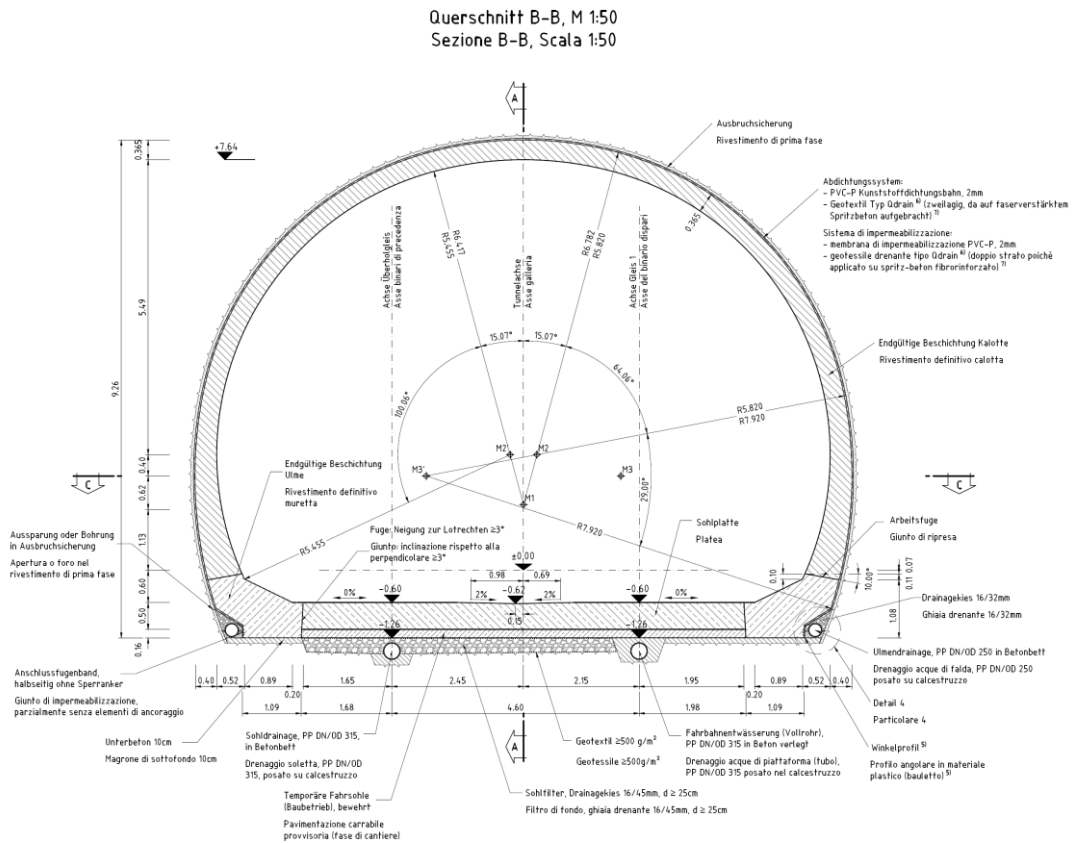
Carpenteria sezione tipo S2-DR-4.6 – classe di avanzamento A0.
